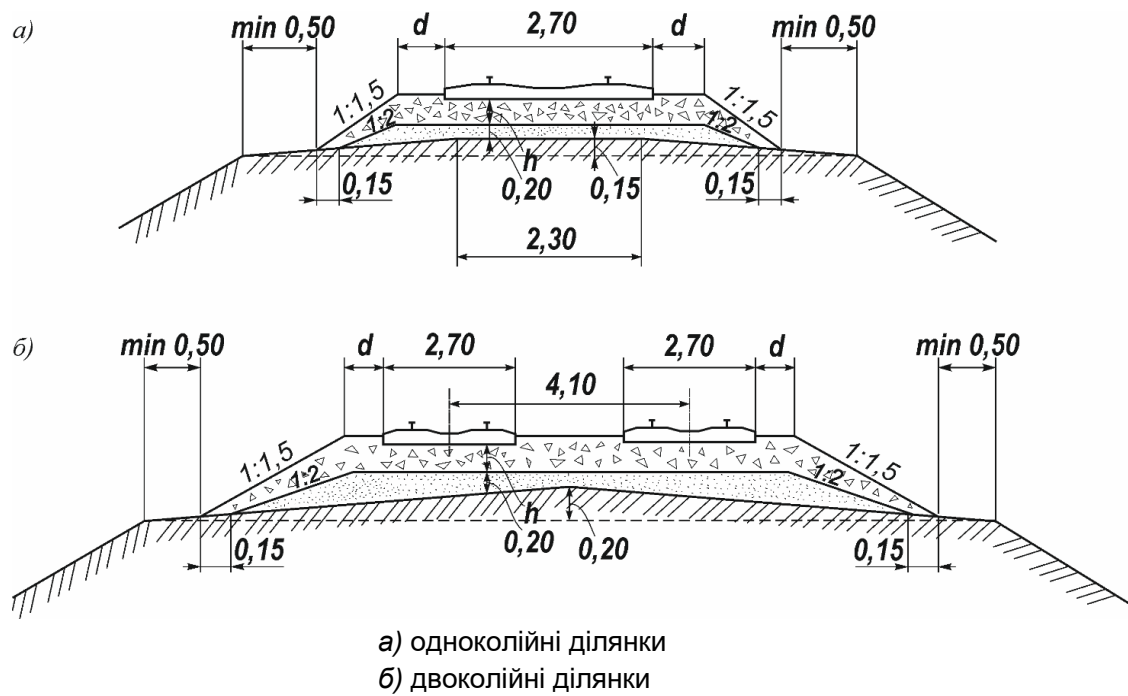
Конструкція баластової призми ВБК на залізобетонних шпалах
